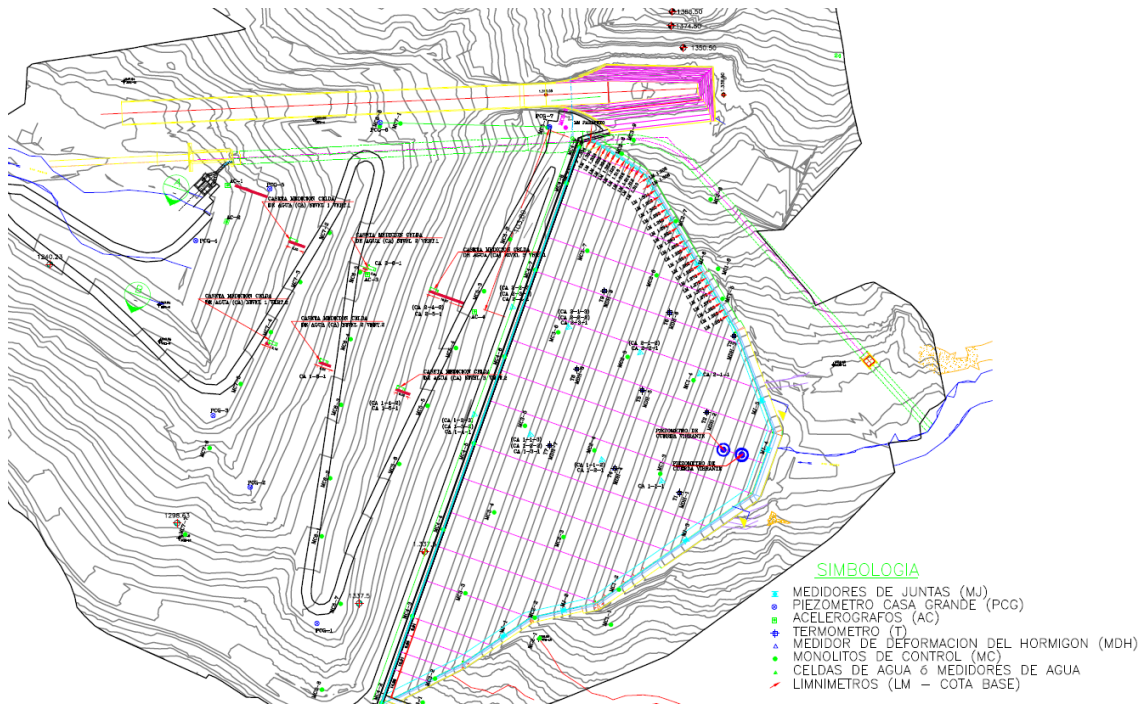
Plano en planta del embalse de Chacrillas (Documento nº 2 – Planos). Fuente: elaboración propia.
